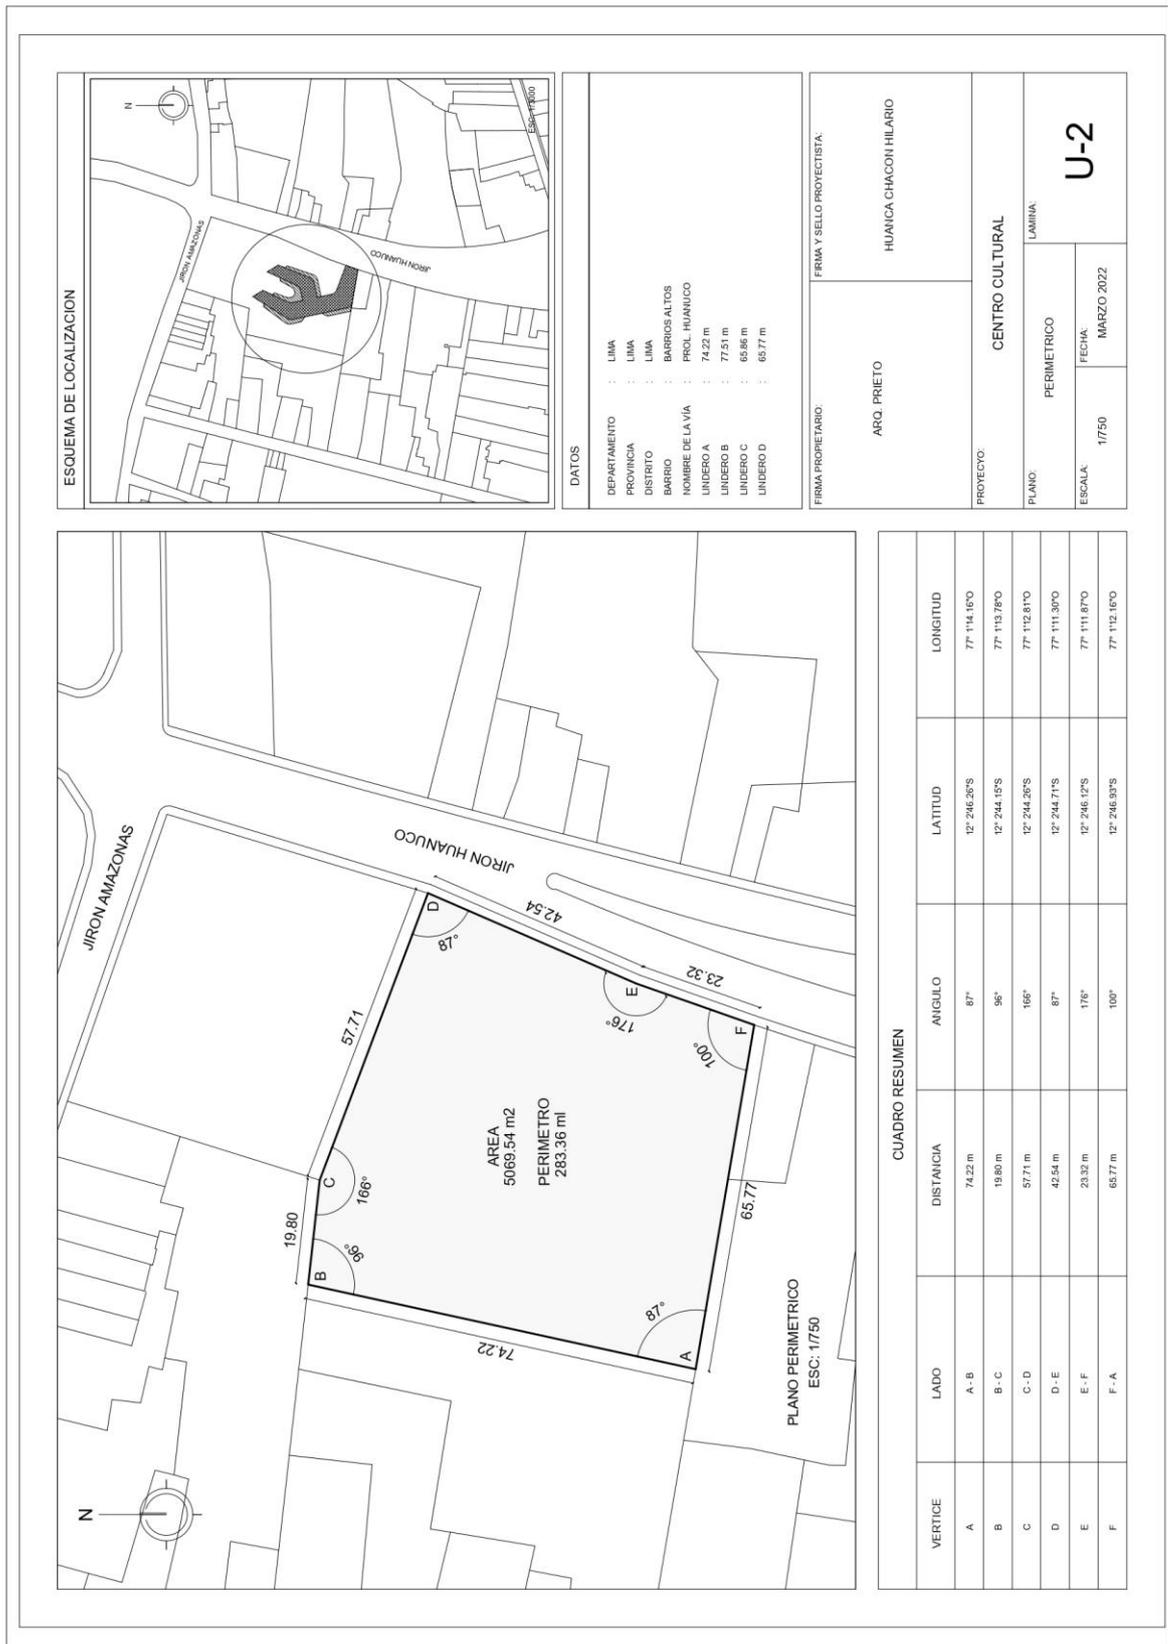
Plano perimétrico del proyecto arquitectónico
